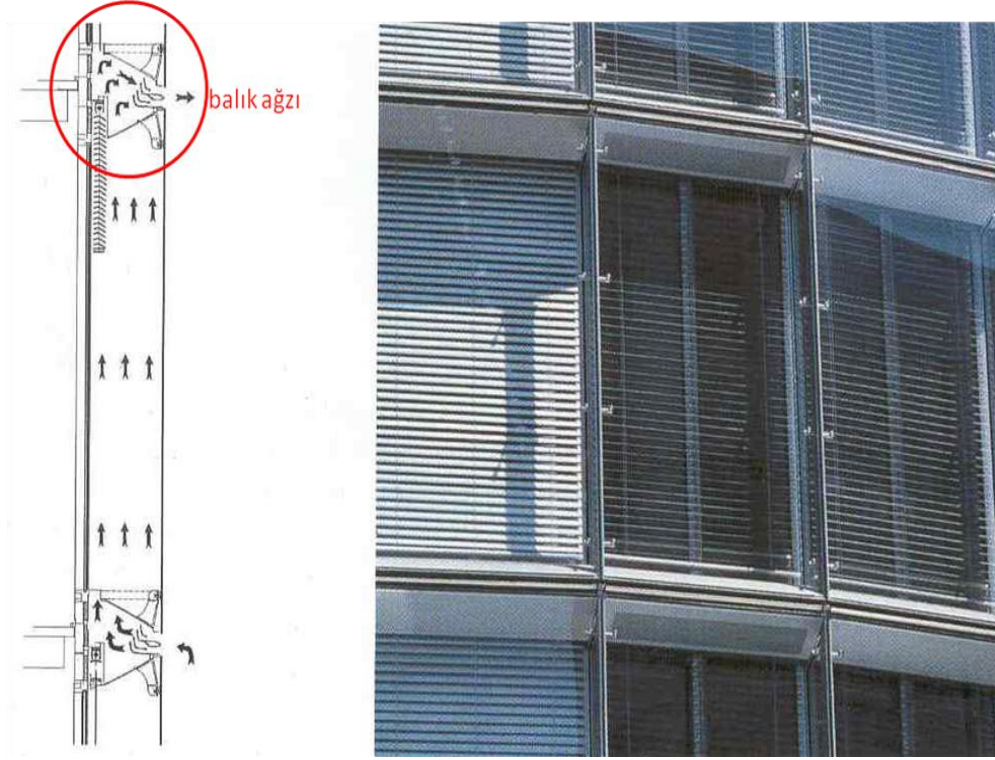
Stadttor İş Merkezi, Düsseldorf [29].
